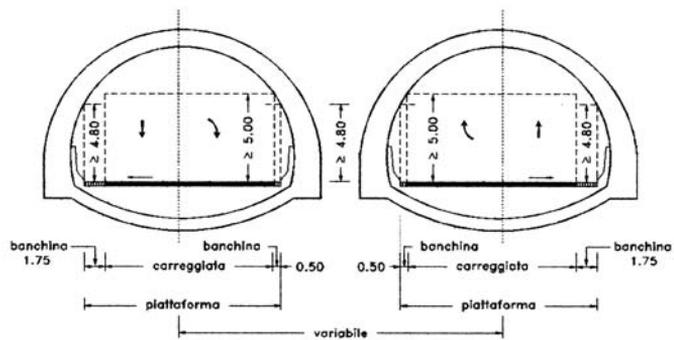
Sezione di una galleria autostradale a doppia canna.
